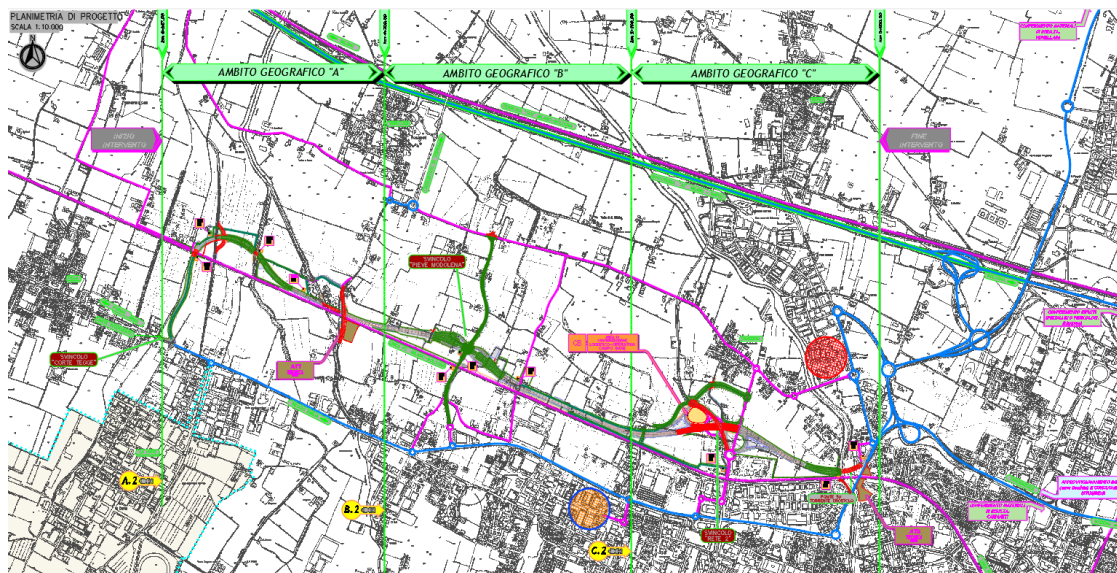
Planimetria sinottica dei percorsi di cantiere durante la Fase 2
